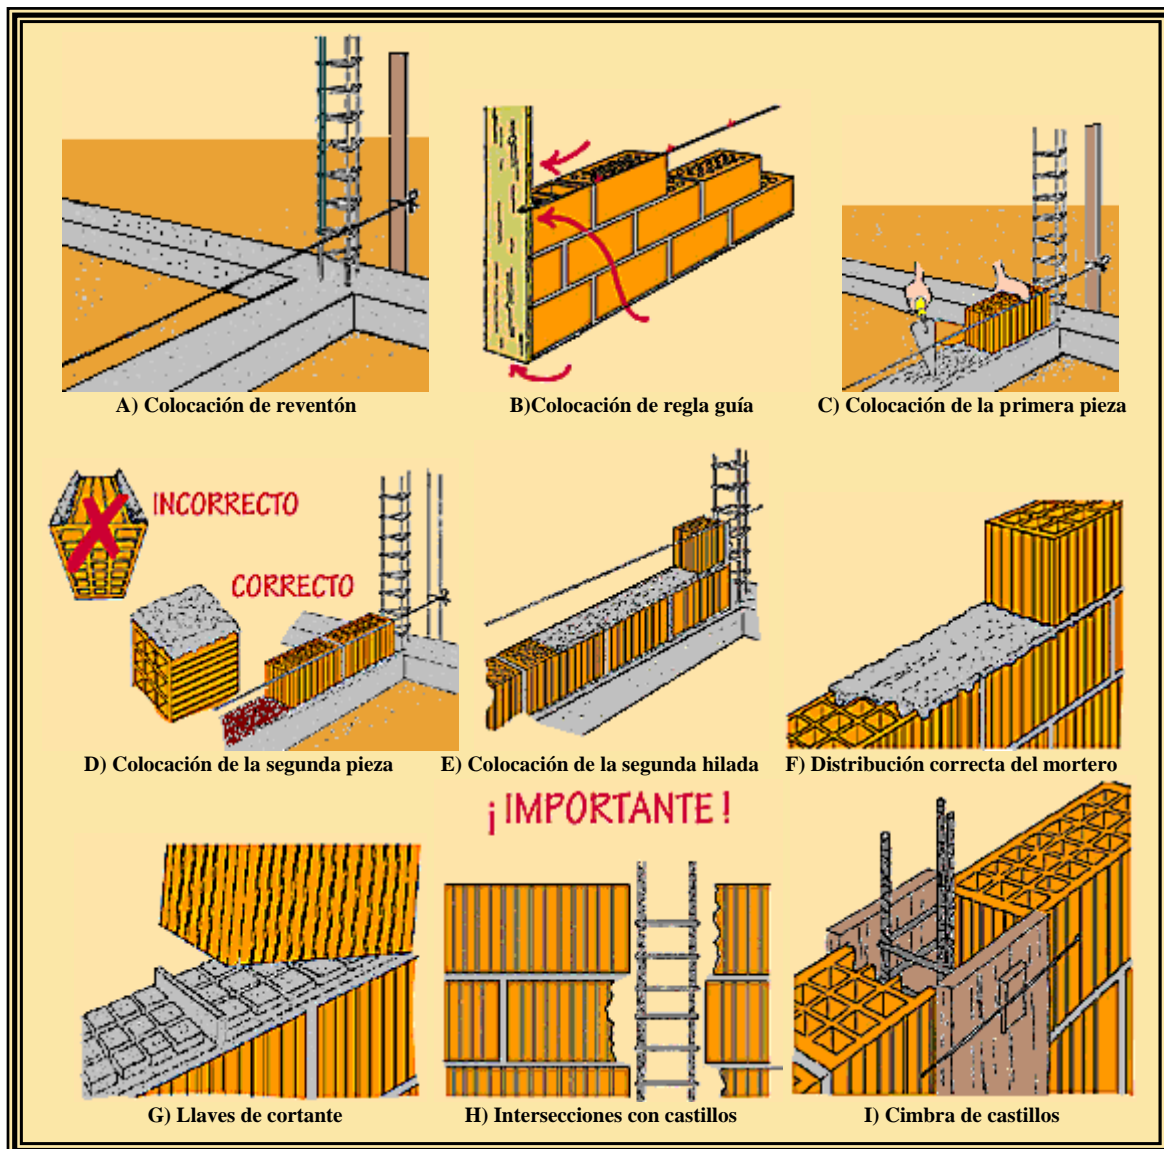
Colocación de piezas en el sistema TABIMAX
